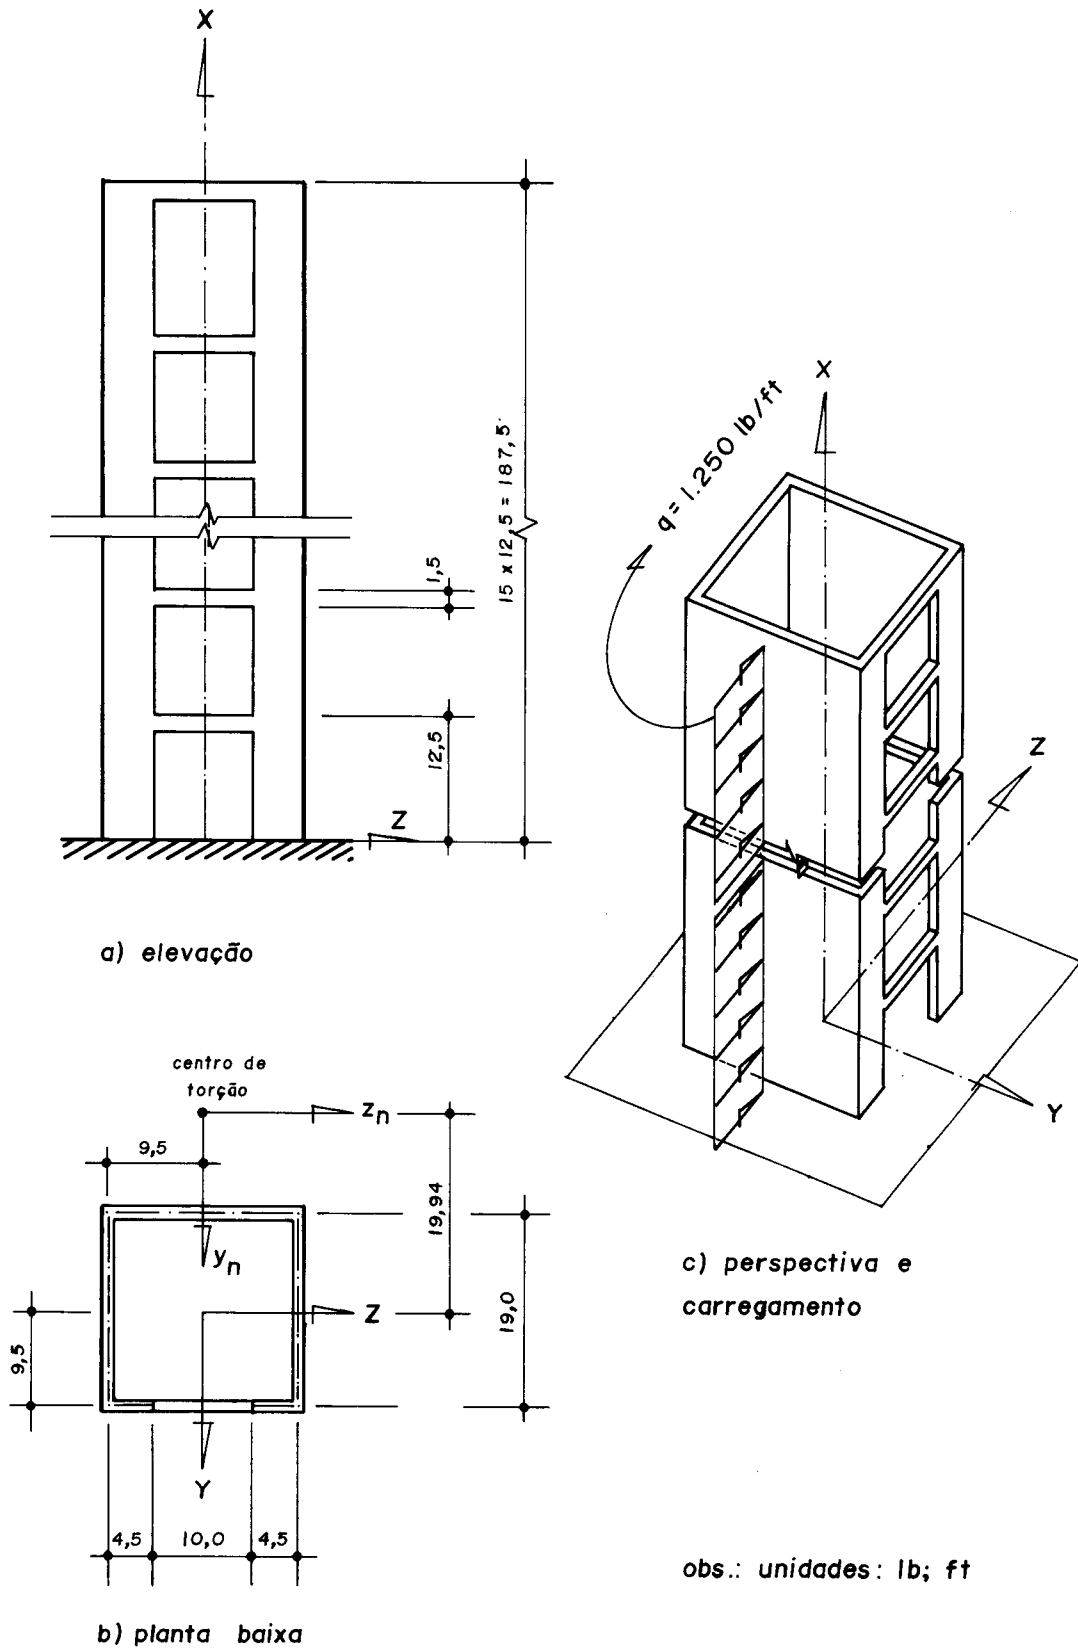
Exemplo nº 1 - elevação, planta baixa e carregamento.
